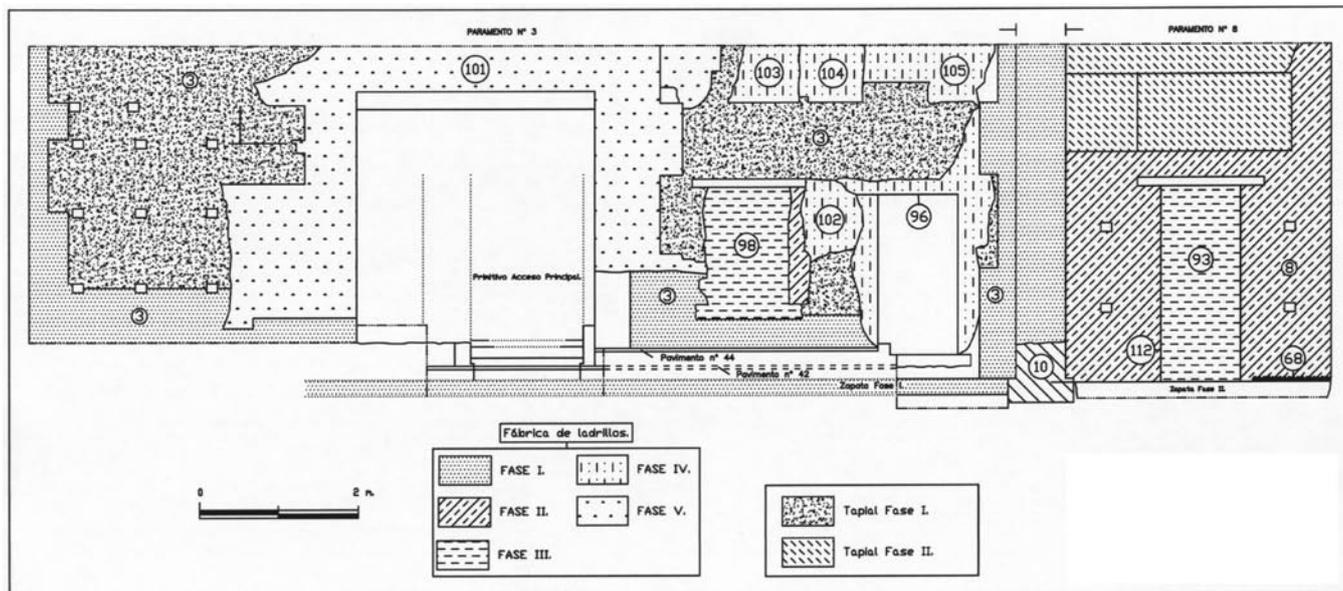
Paramento central (nº 8 y 3). Planta baja. Alzado norte. Análisis estratigráfico con diferenciación de fases constructivas.
